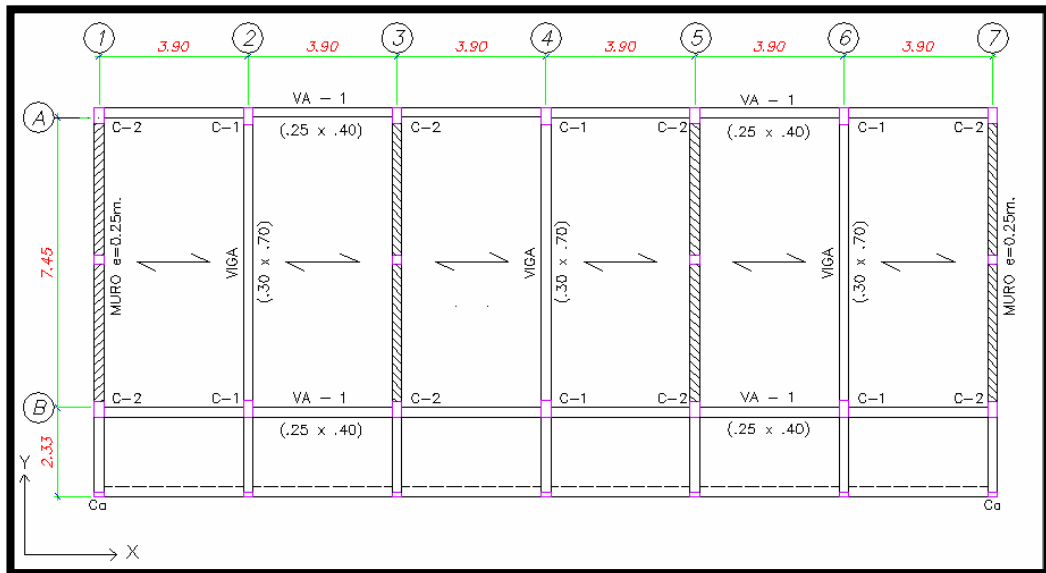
Vista en planta del sistema estructural del edificio 780 pre NDSR 1997
